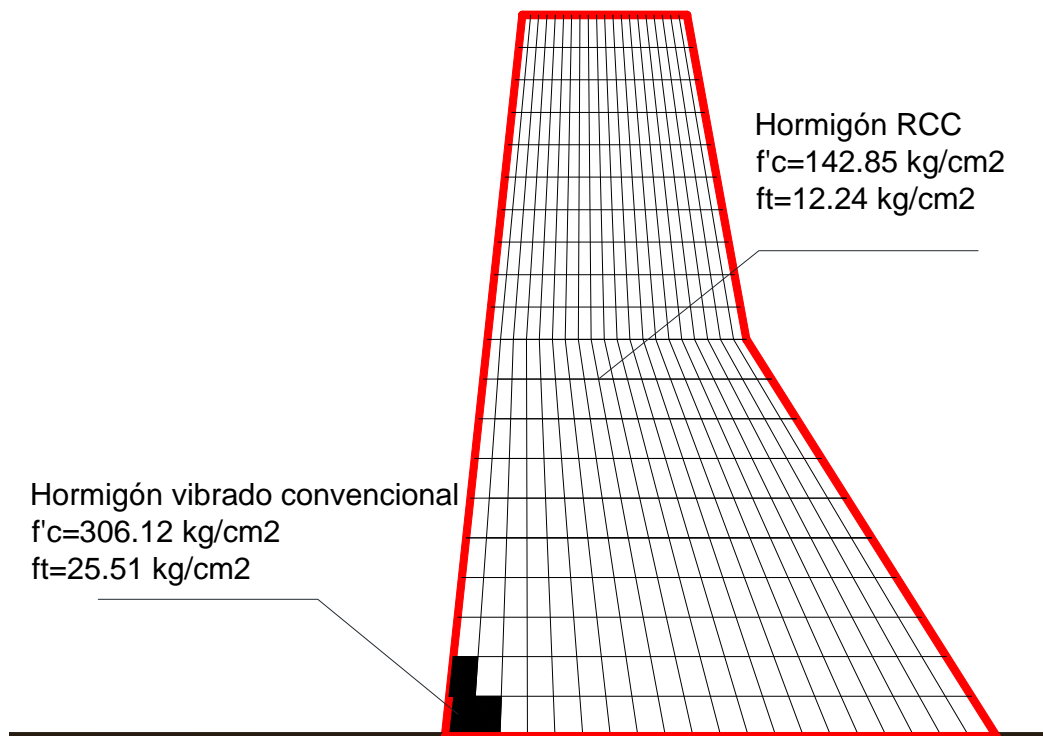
28 Hormigón RCC y Vibrado Cargas Extremas.
